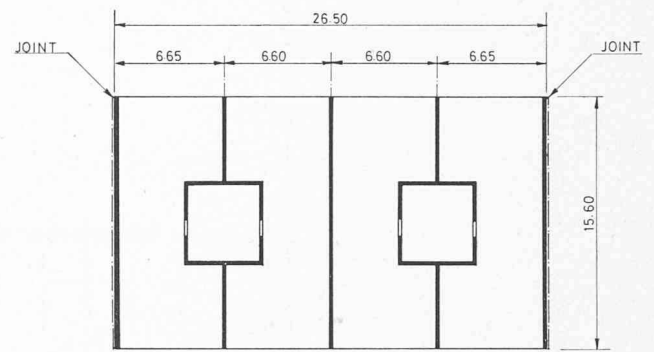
Immeuble d'habitation du Lignon, Genève 1965. Vue en plan. Structure avec noyaux et parois.
